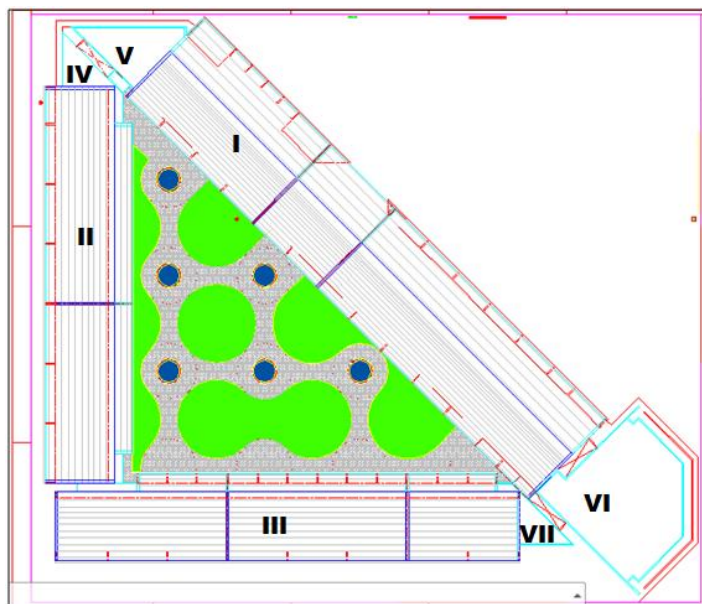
Planta de cobertura do prédio principal do Campus do Sertão.
